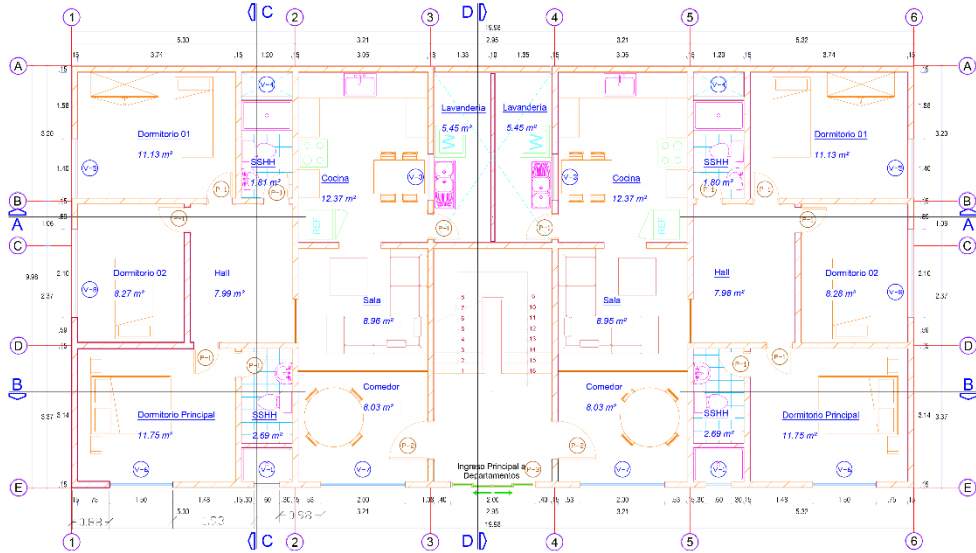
Plano Arquitectónico de la Distribución de Planta del 1º Nivel.
